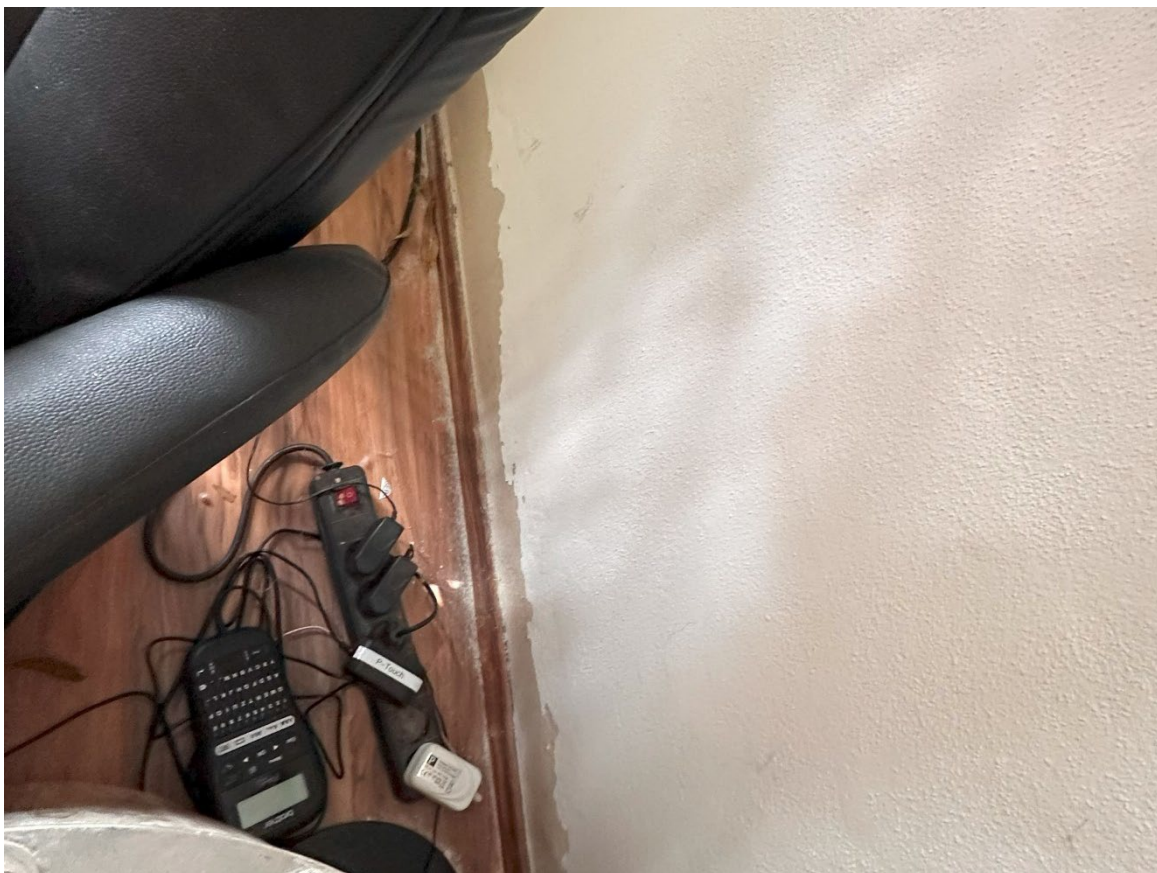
Wohnung Top 1 | westliches Zimmer | Wandbeläge im Bereich der Sesselleisten
